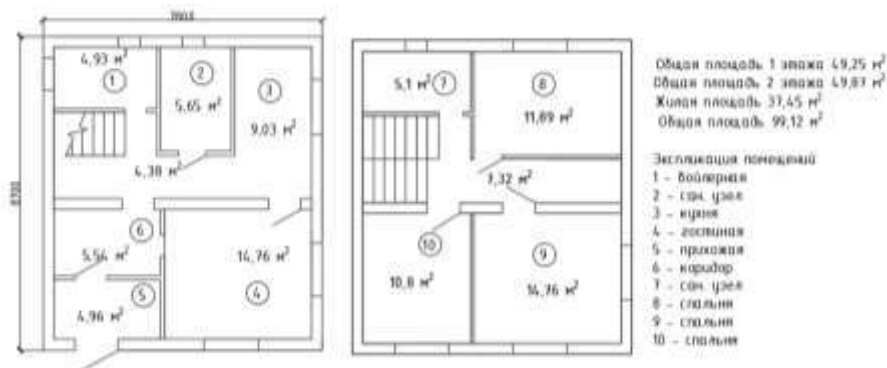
План двухэтажного дома со стенами из газобетонных блоков
